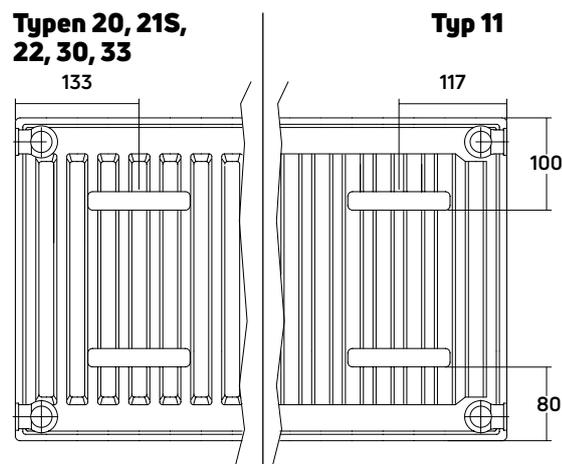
Laschenmaße für Compact mit Befestigungslaschen (Rückansicht)
